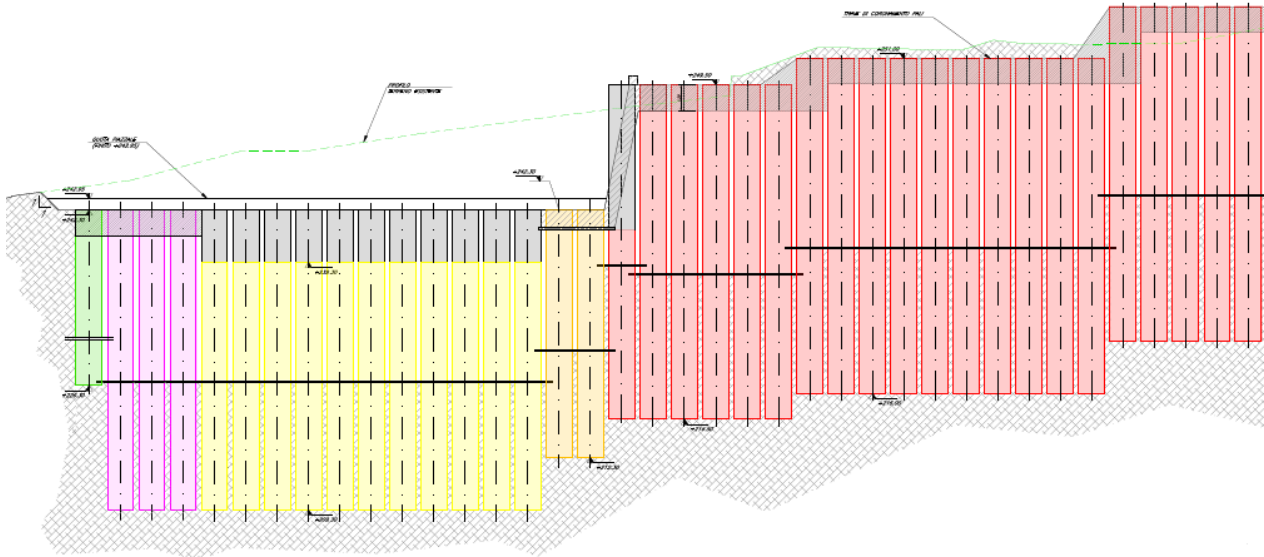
Sezione longitudinale dell'intervento di mitigazione (Doc. Rif. [26])
